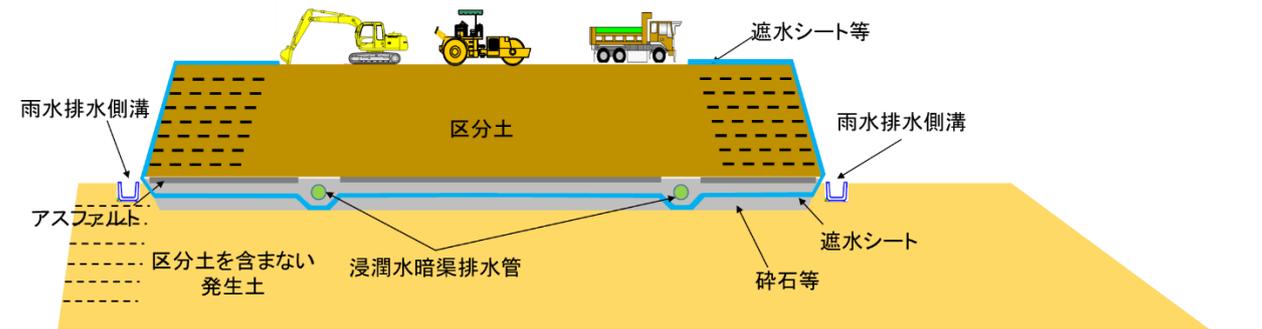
(1) 主な施工手順（アスファルト舗装施工）
